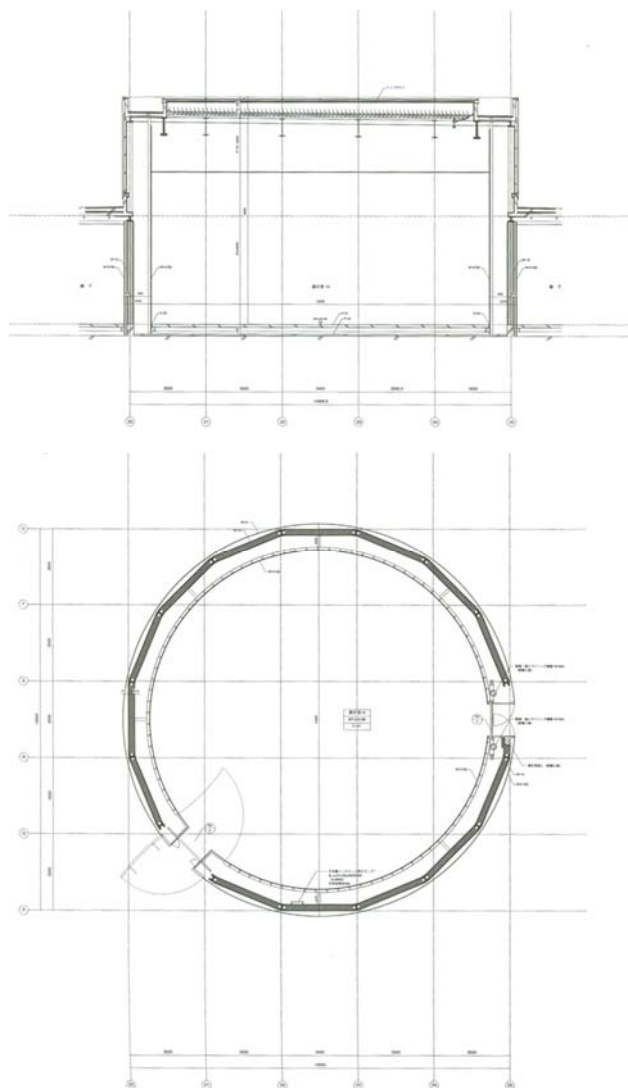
Sala (14) de exposições temporárias (diâmetro 15 x 9 metros), planta e corte.
